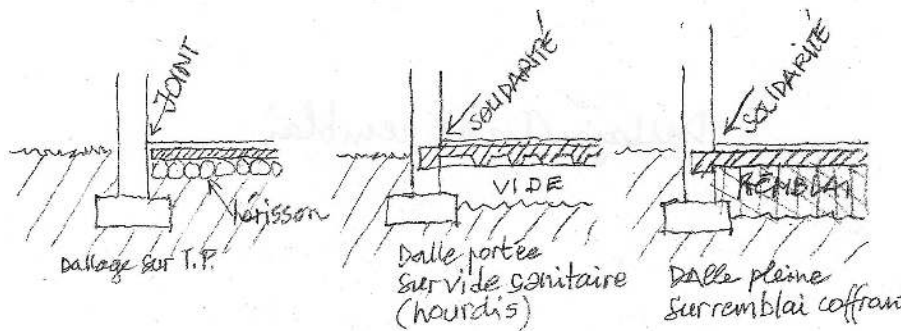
Forme sous dallage, dalles sur vide et sur remblai coffrant
